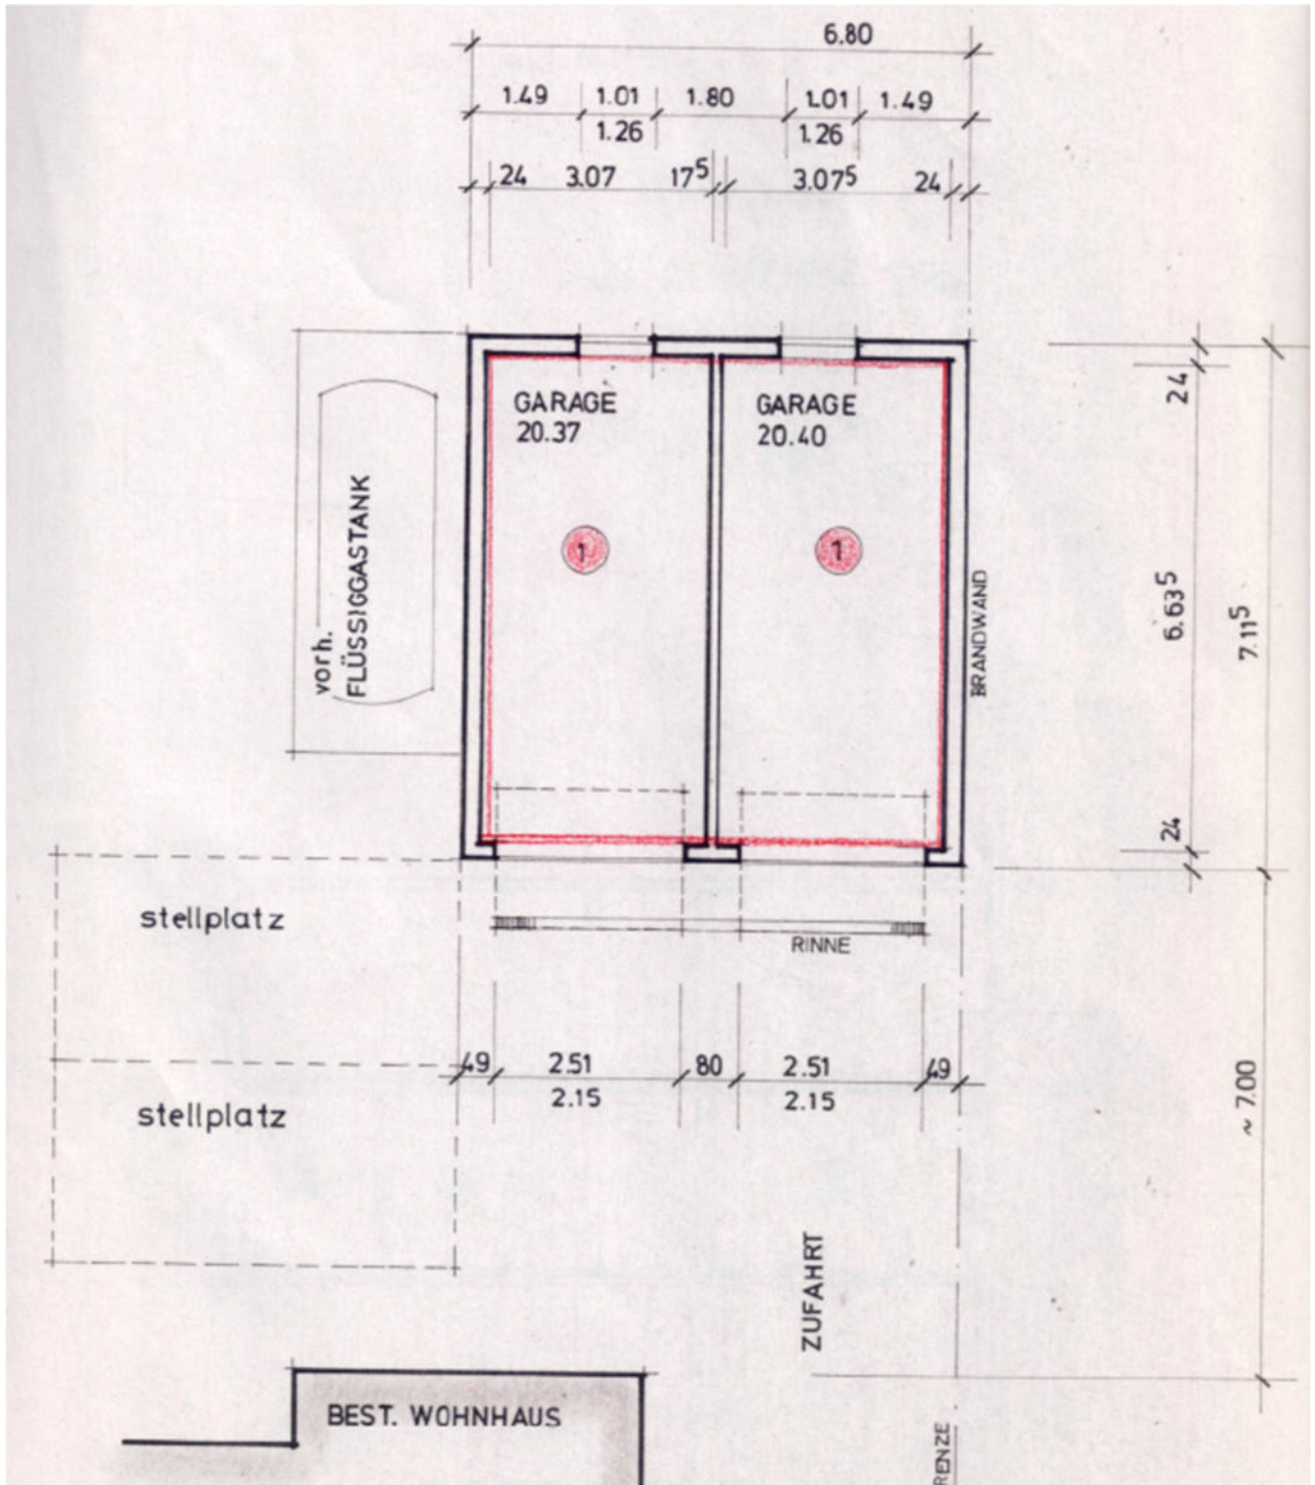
Grundriss der Doppelgarage zu Sondereigentum Wohnung Nr. 1 sowie Markierung der Kfz-Stellplätze im Hof; Quelle: Teilungserklärung vom 30.12.1998 (UR-Nr. 156/98), Aufteilungspläne
